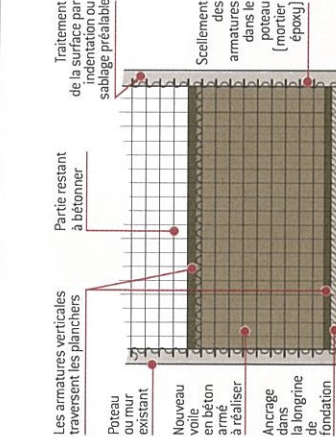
Exemple de renforcement du contreventement d'un bâtiment par création de murs nouveaux entre deux poteaux existants (élévation)
